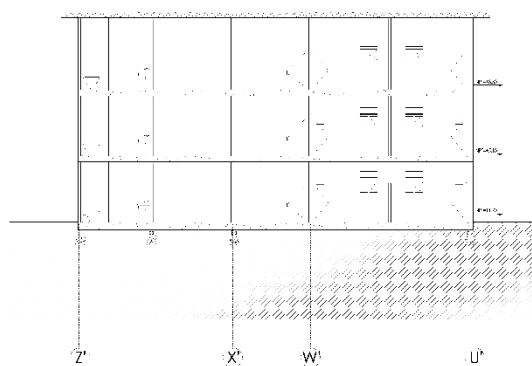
41 Fachada lateral izquierda Centro de Salud
